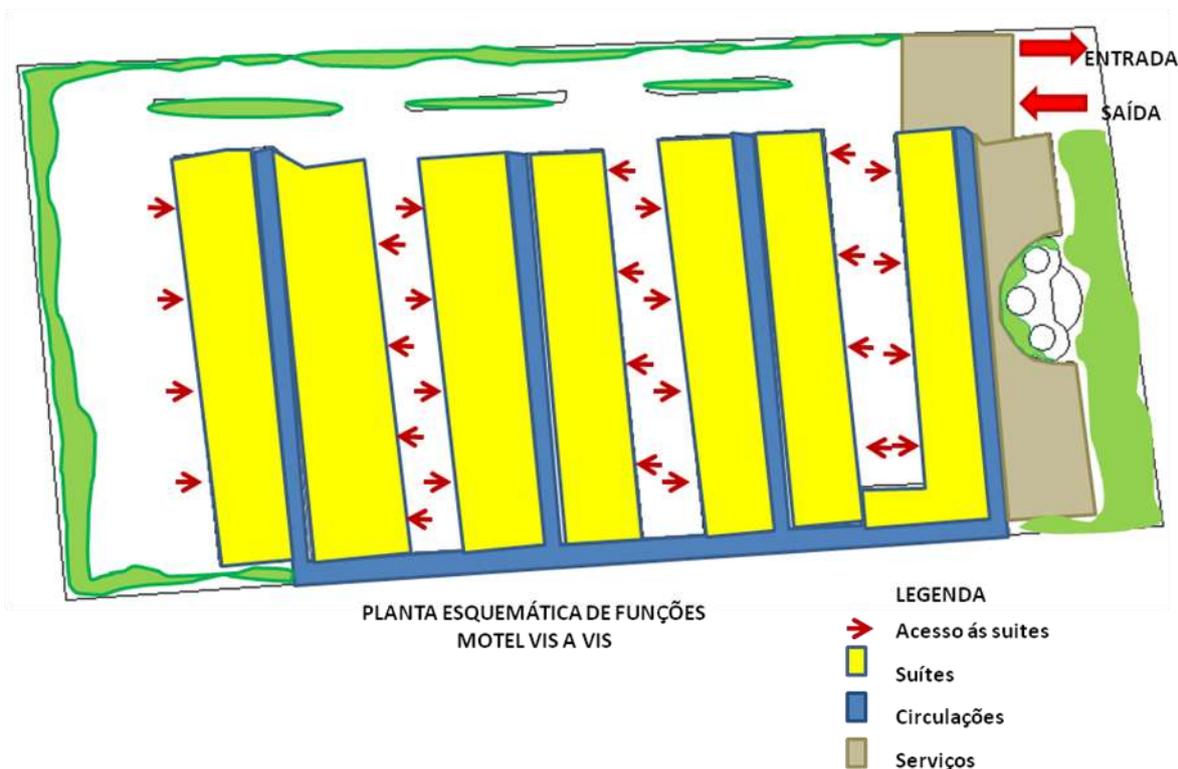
Planta esquemática de funções do estabelecimento (AUTORA, 2010).
